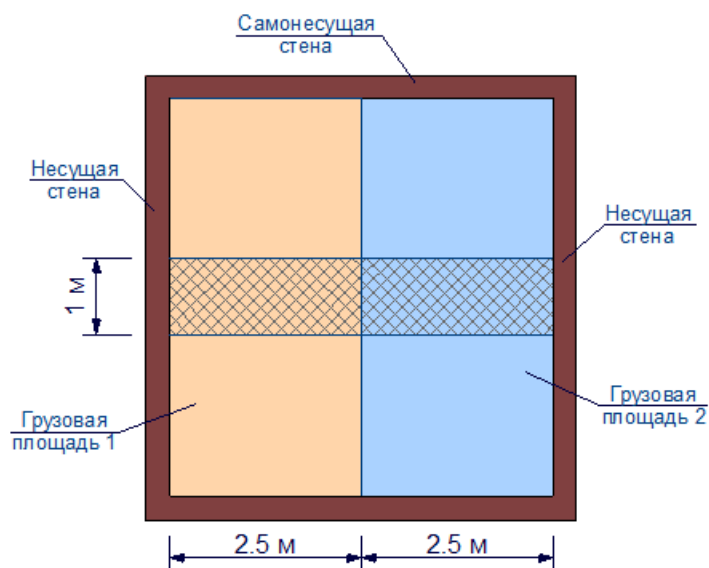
Схема определения грузовой площади ленточного фундамента (поперечные несущие стены)
